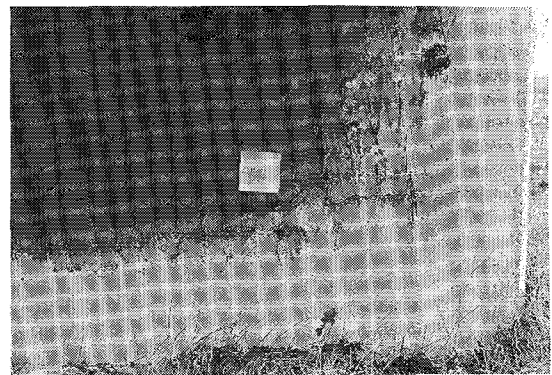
基礎コンクリートのひびわれ (ベランダ下)
